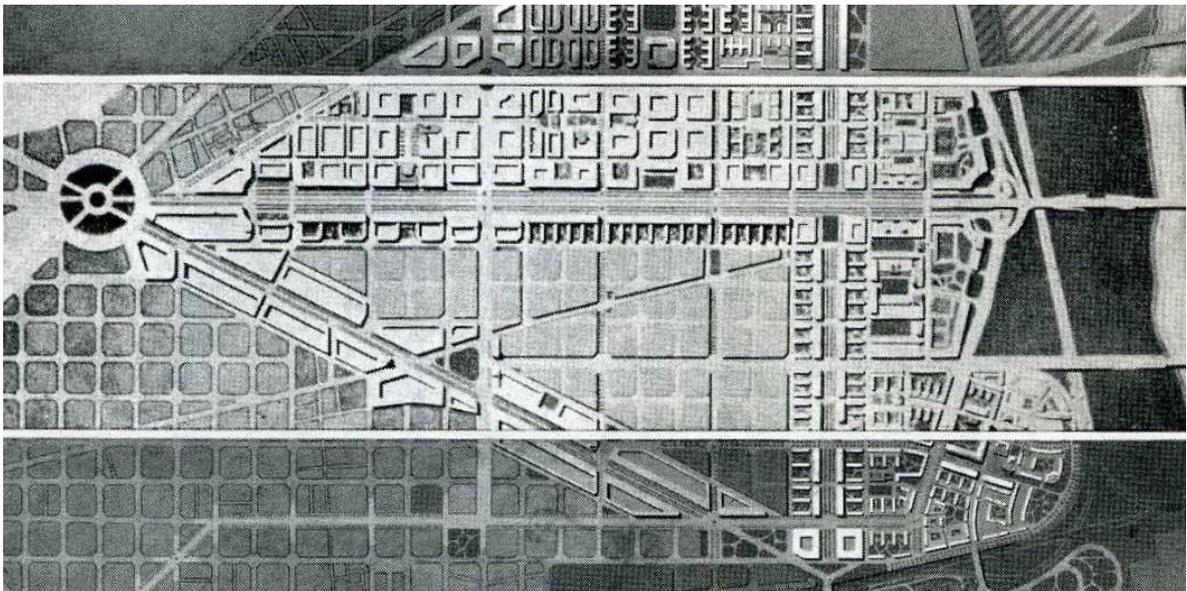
Plan Parcial de Levante con ordenación de edificación abierta en torno a los ejes de Gran Vía, Guipúzcoa y Rambla de Prim.
